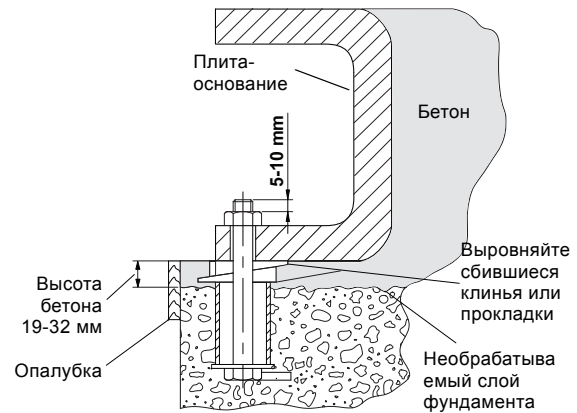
Фундамент с установленными фундаментными болтами, бетонной заливкой и плитой-основанием
